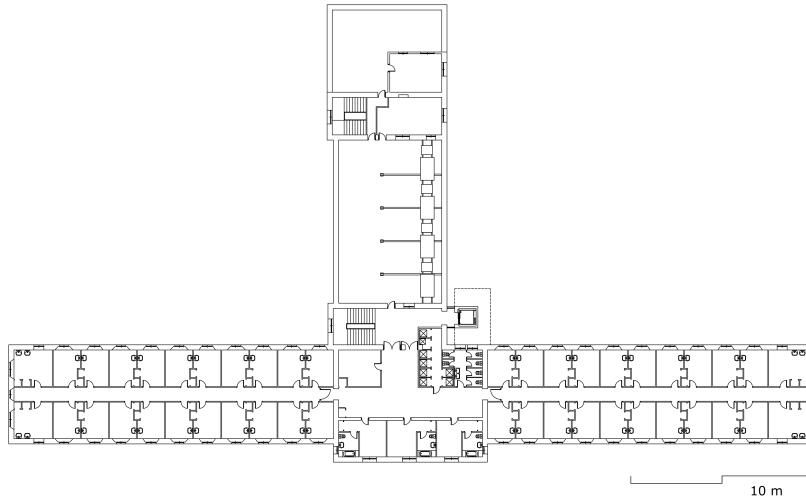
Plano de primera planta del Colegio Mayor Hernando Colón.
